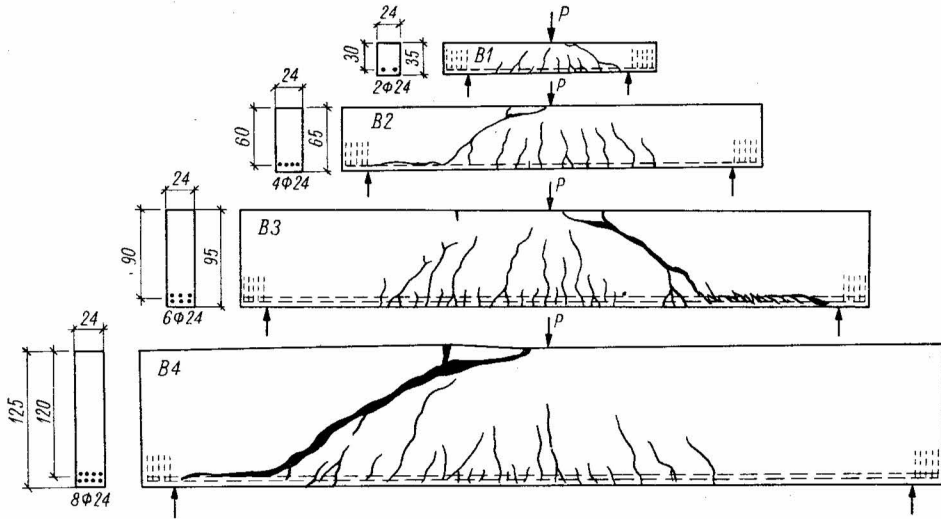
Fissuration des poutres  $B_1$  à  $B_4$  en état d'épuisement de la capacité portante
